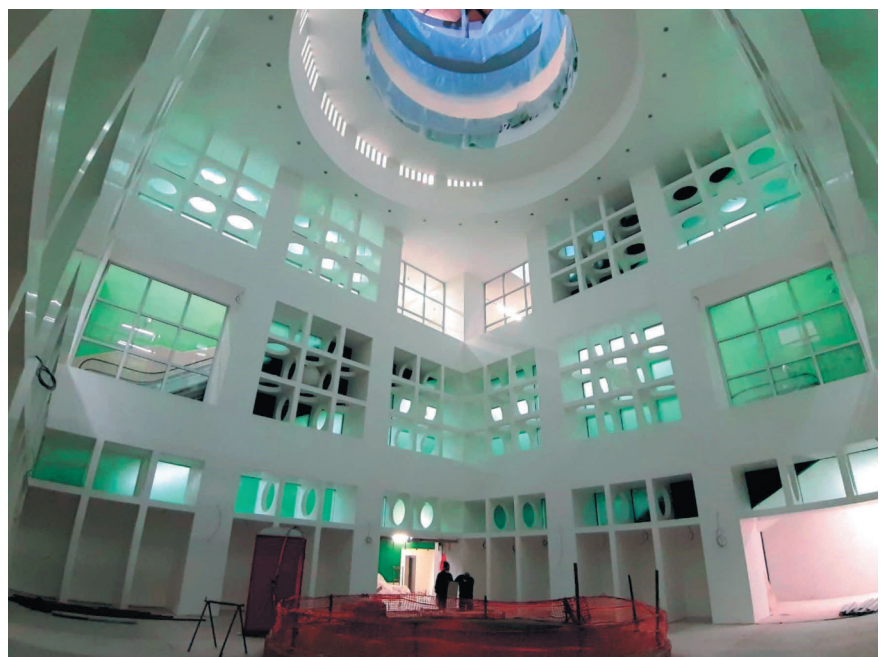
Esempio di foto dal cantiere della lanterna interna.
